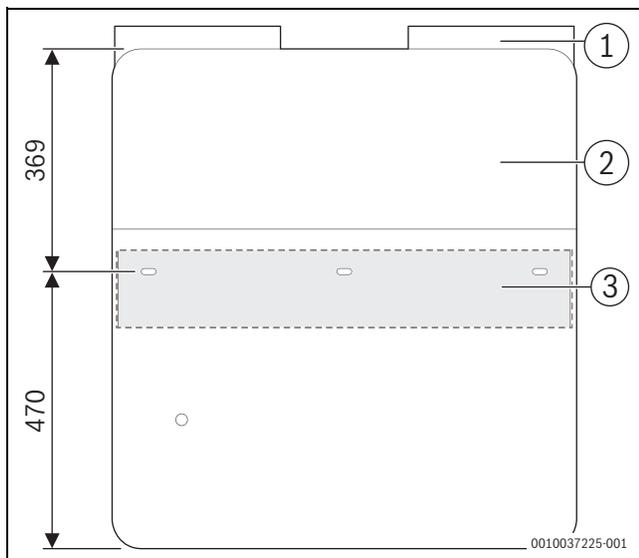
Einbaumaße autarke Installation des Lüftungsgeräts
